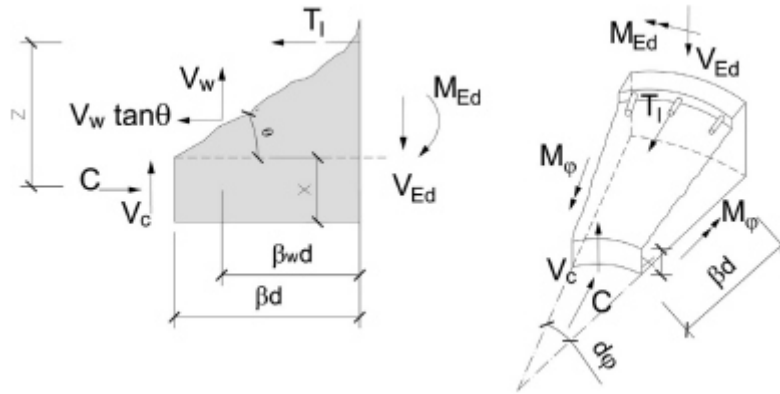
Equilibrio de fuerzas en cuña de hormigón por debajo de la fisura (Marí, Cladera, Oller, & Bairán, 2018).
